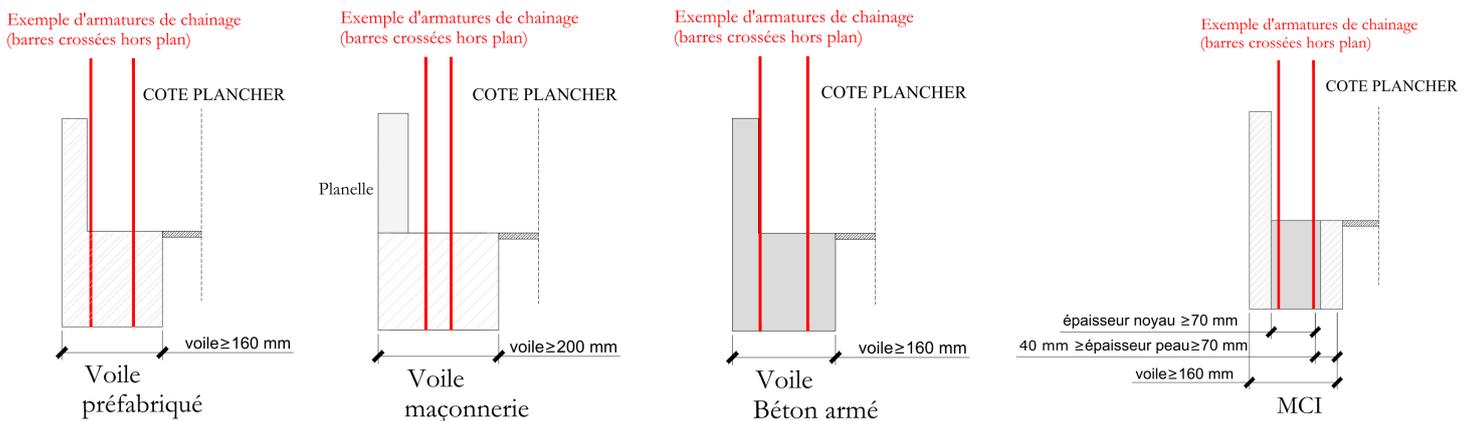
Détail de la construction du mur avec mise en place du coffrage de rive après coup
